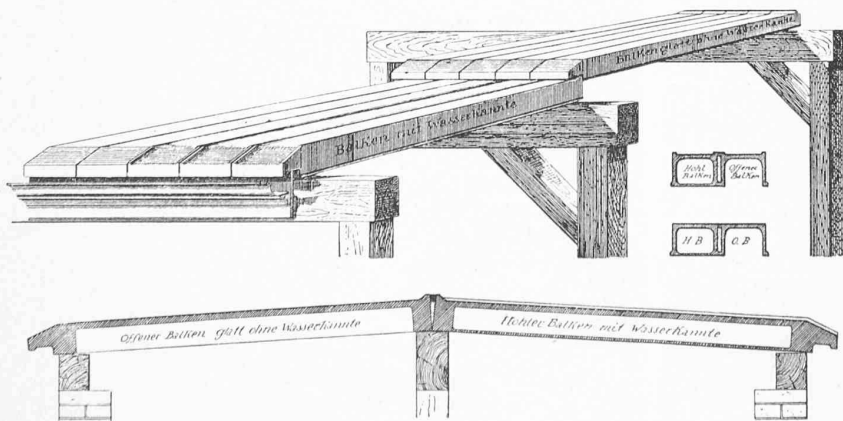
CONSTRUCTION D'UNE TOITURE EN TERRASSE
